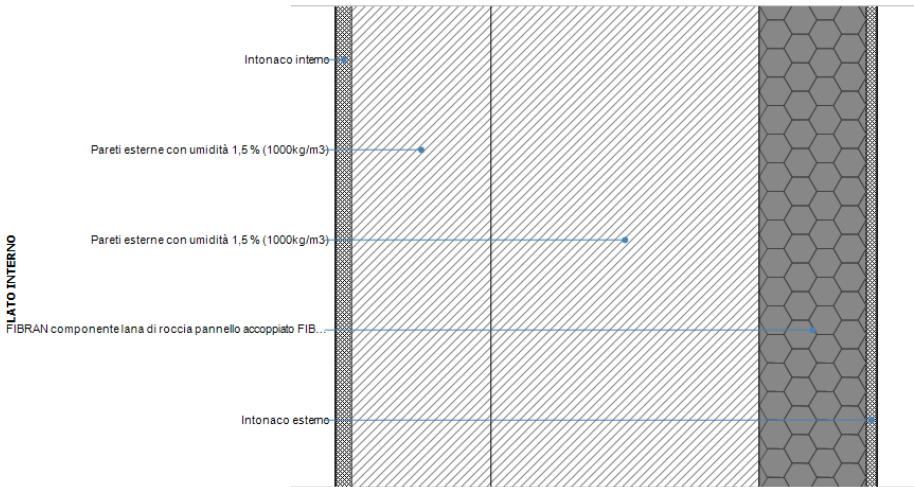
Sezione corrente della parete esterna isolata con sistema a cappotto
